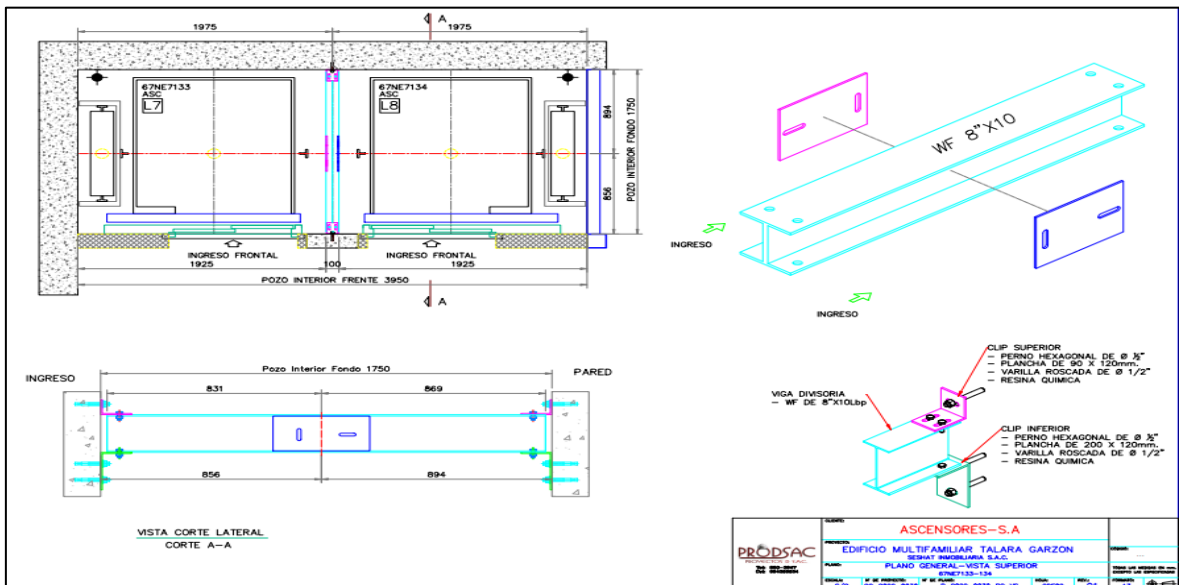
Vista de planta del plano de montaje de vigas divisoras proyecto 1
